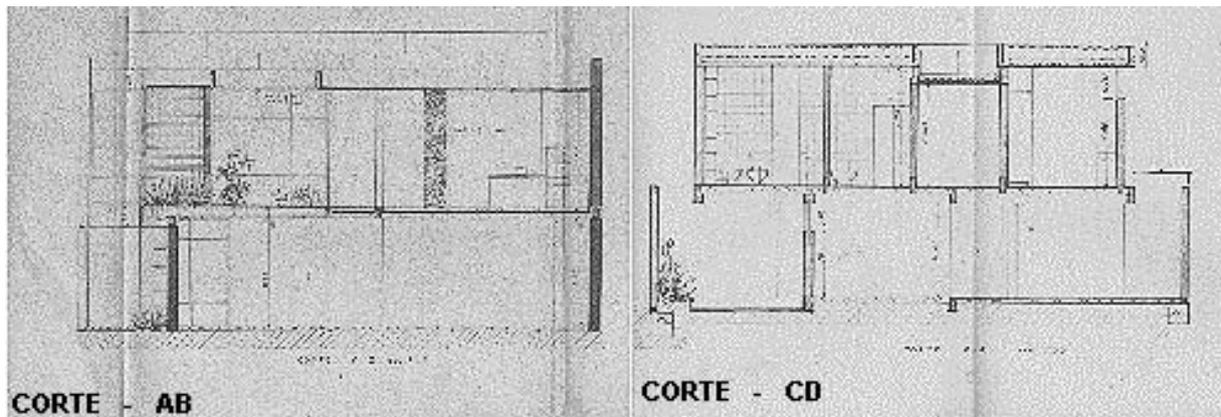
Cortes AB e CD do desenho original de Élcio. Fonte: Levantamento feito por Patrícia Pimenta para o Núcleo de Teoria e História da FAUeD UFU.
